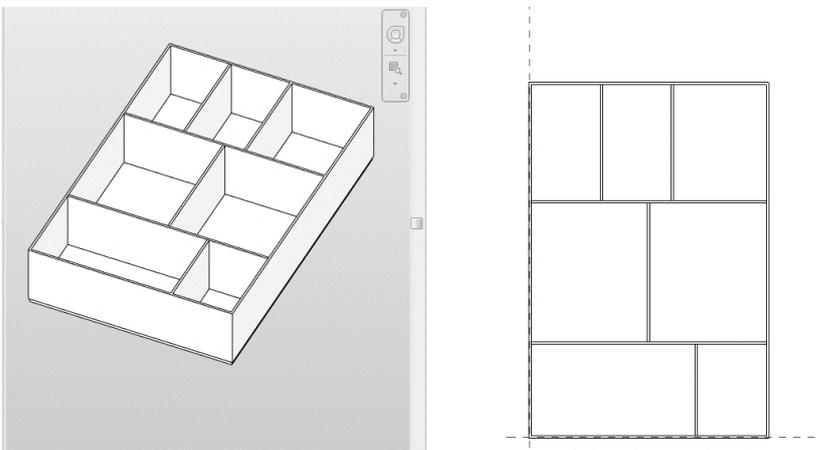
3D-Ansicht (links) und Grundriss (rechts) des erzeugten Wohnungslayouts (eigene Darstellung)
